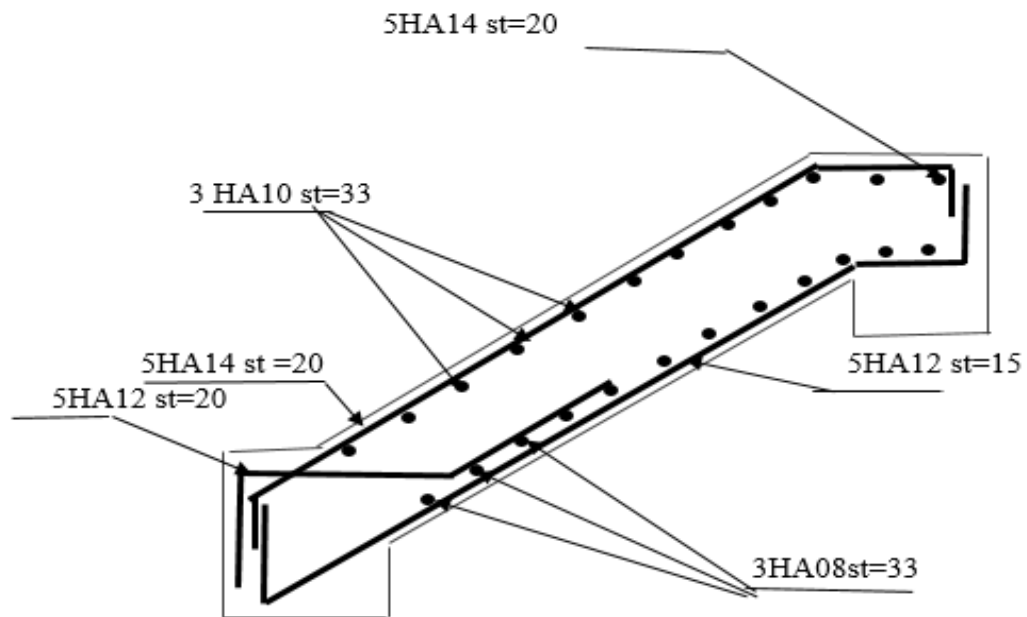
Schéma de ferrailage d'escaliers type 01
